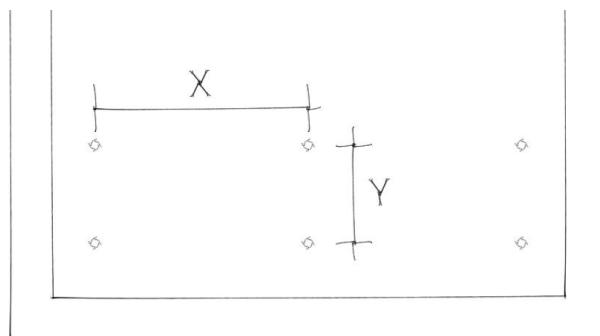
Traçage pour un positionnement correct des chevilles de contraste sur la dalle
